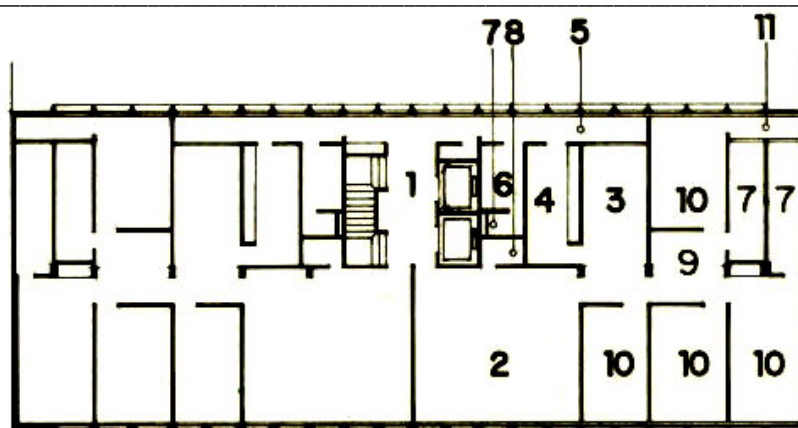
planta do pavimento tipo: 1) hall do elevador; 2) estar; 3) estar íntimo; 4) cozinha; 5) serviço; 6) q. empregada; 7) banheiro; 8) lavabo; 9) hall íntimo; 10) dormitório; 11) terraço.
